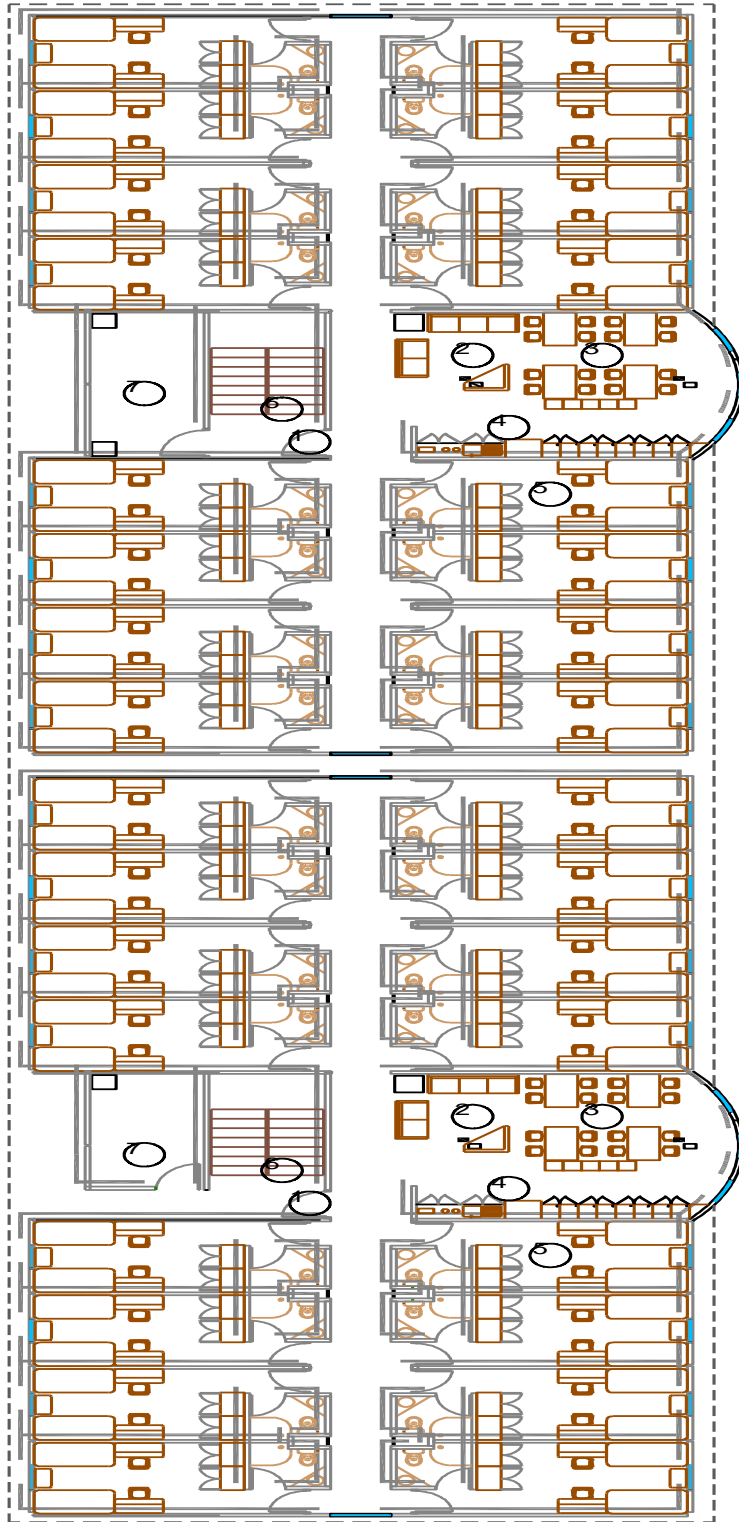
Distribución de los espacios de la planta baja de dormitorios.
